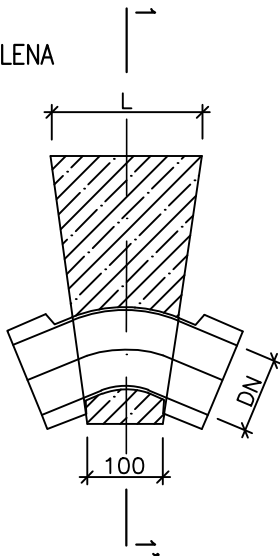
DETAIL ZAJIŠŤOVACÍCH OPĚRNÝCH BLOKŮ
